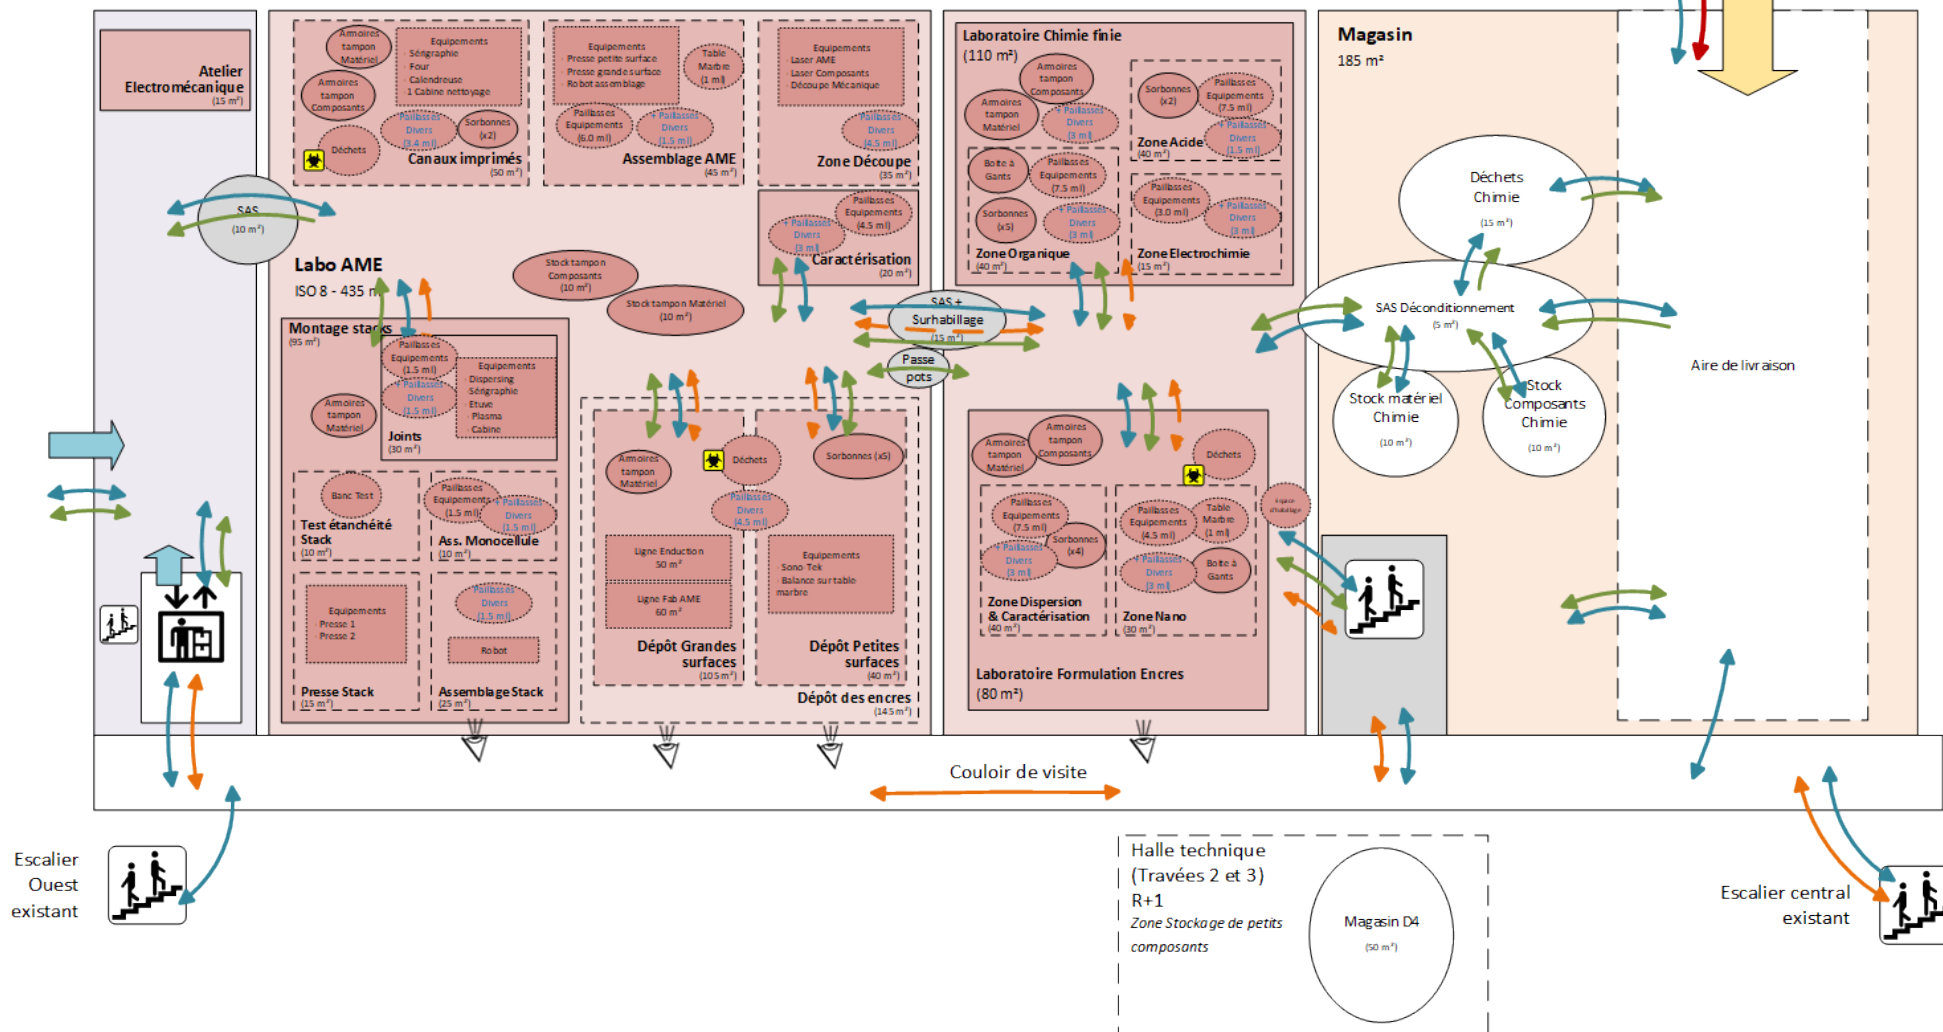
Plan Fonctionnel - niveau RDC (Nord en haut)
